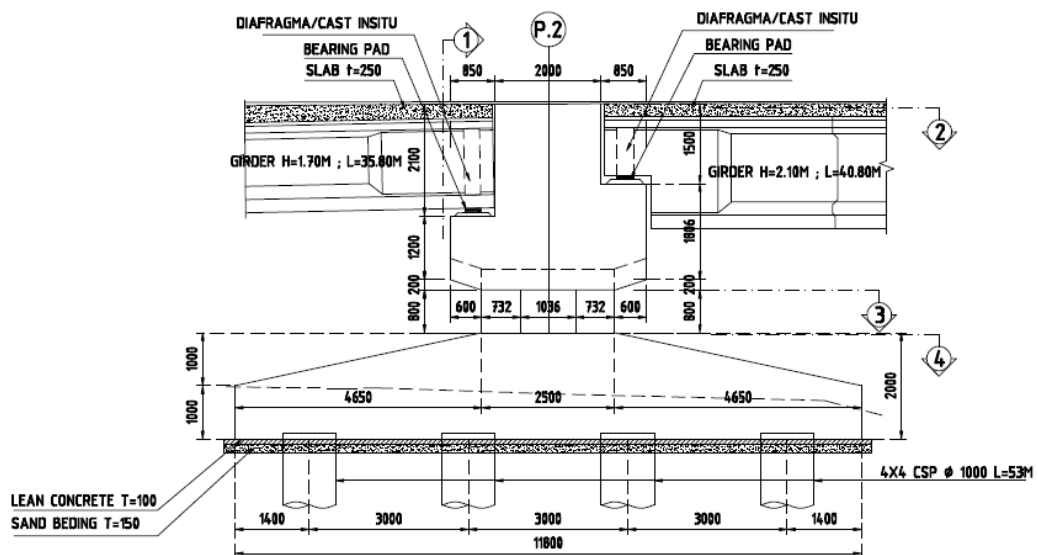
1 Denah Jembatan Sironboyo Pacitan
